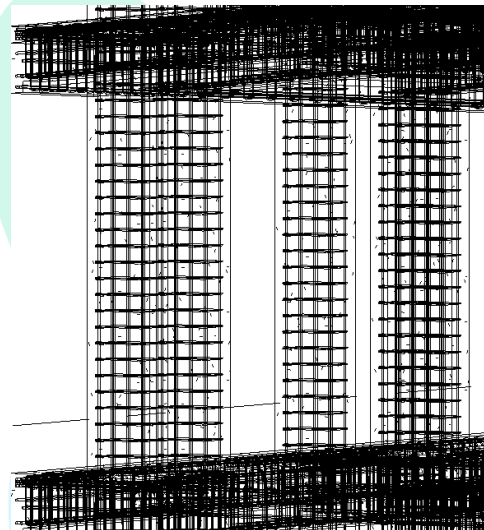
14 Corewall dan pembesian yang telah terbentuk pada Revit
